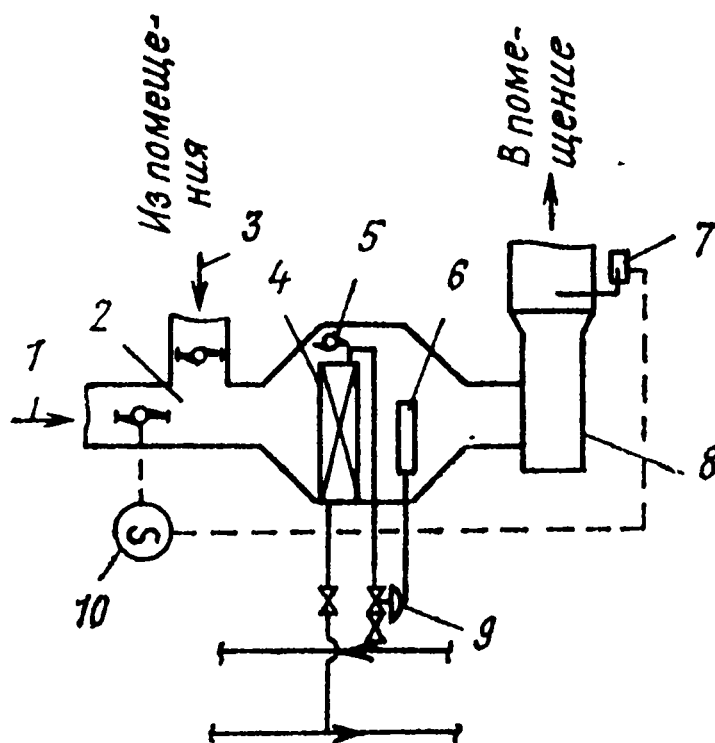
Схема присоединения систем вентиляции к тепловой сети
